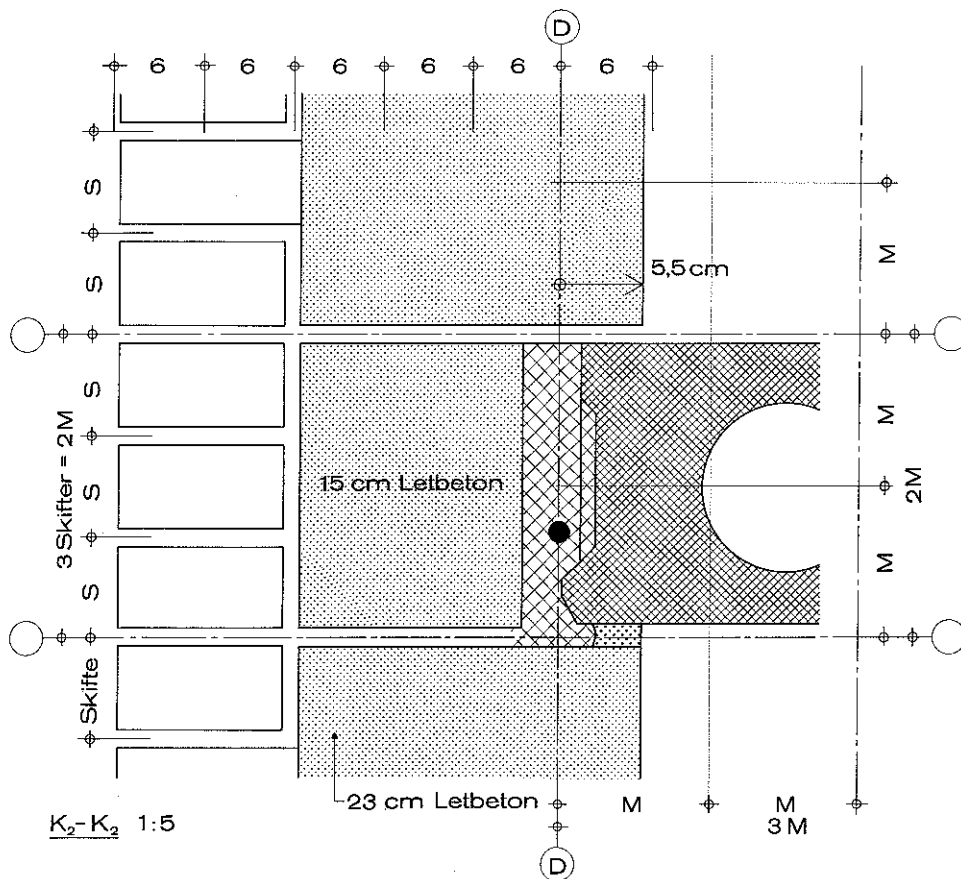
Dæk - letbetonfacade - lodrette facadebånd; - og der kan laves mange flere. Ingen uniformering af modulprojekterne!
